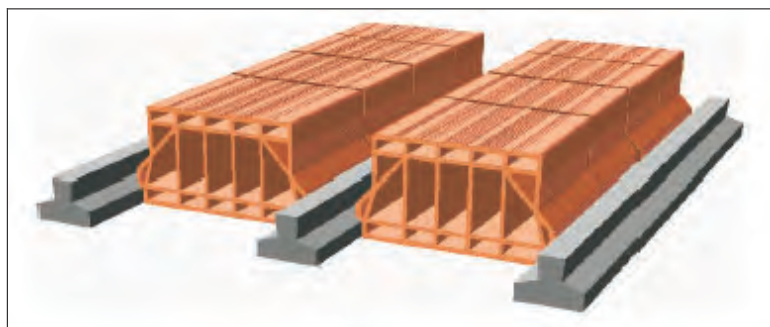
Spaccato solaio in laterocemento a travetti in c.a.p. (fonte Laterizificio Pugliese)
